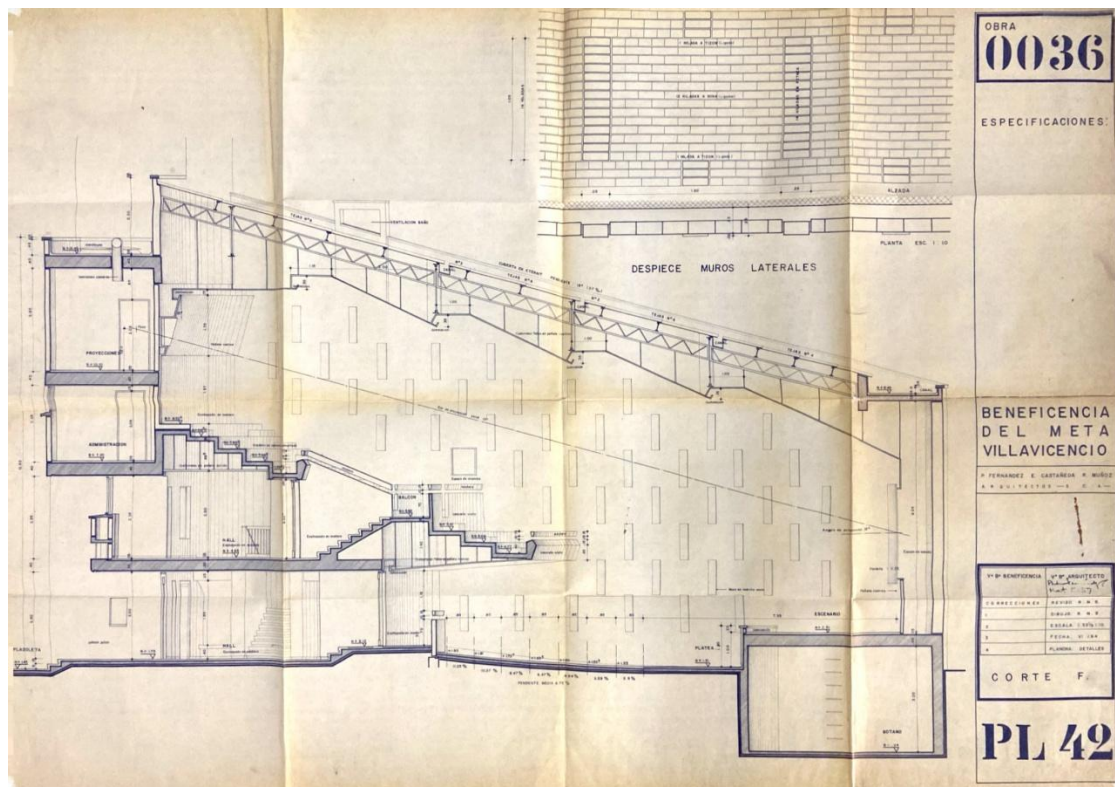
Plano 42, Corte F del Proyecto. Arquitectos: P. Fernández, E. Castañeda y R. Muñoz. Dirección de Archivo General de Villavicencio.
